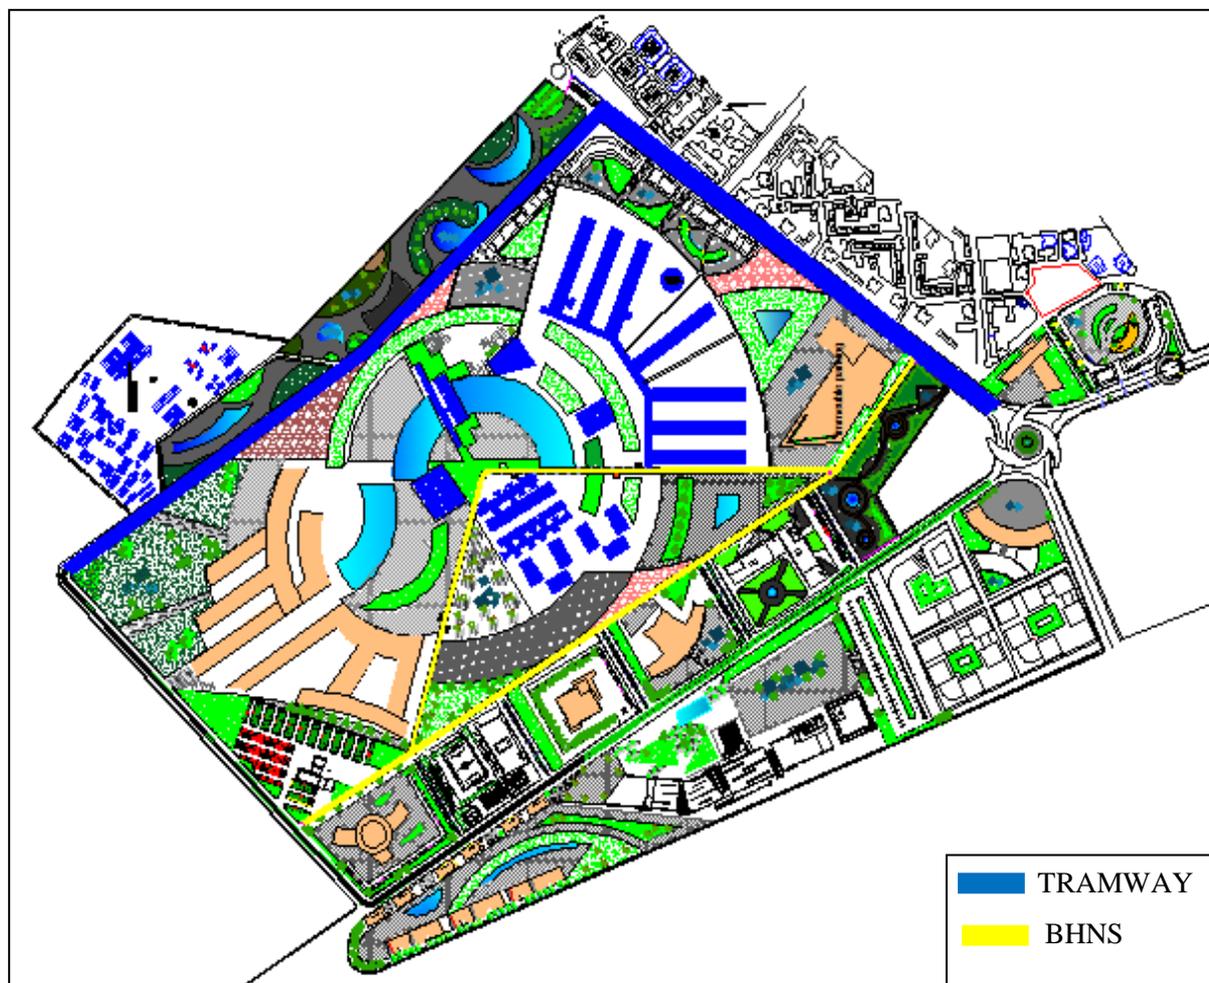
Vue en plan de la structure viaire à l'intérieur du campus
